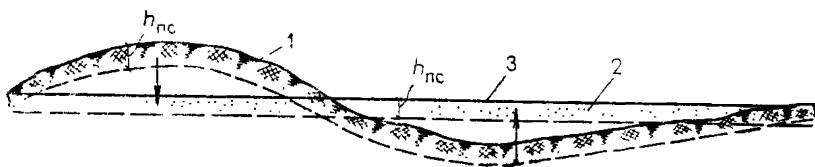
Схема вертикального перемещения растительного грунта на участке зелени, подвергнутом планировке
